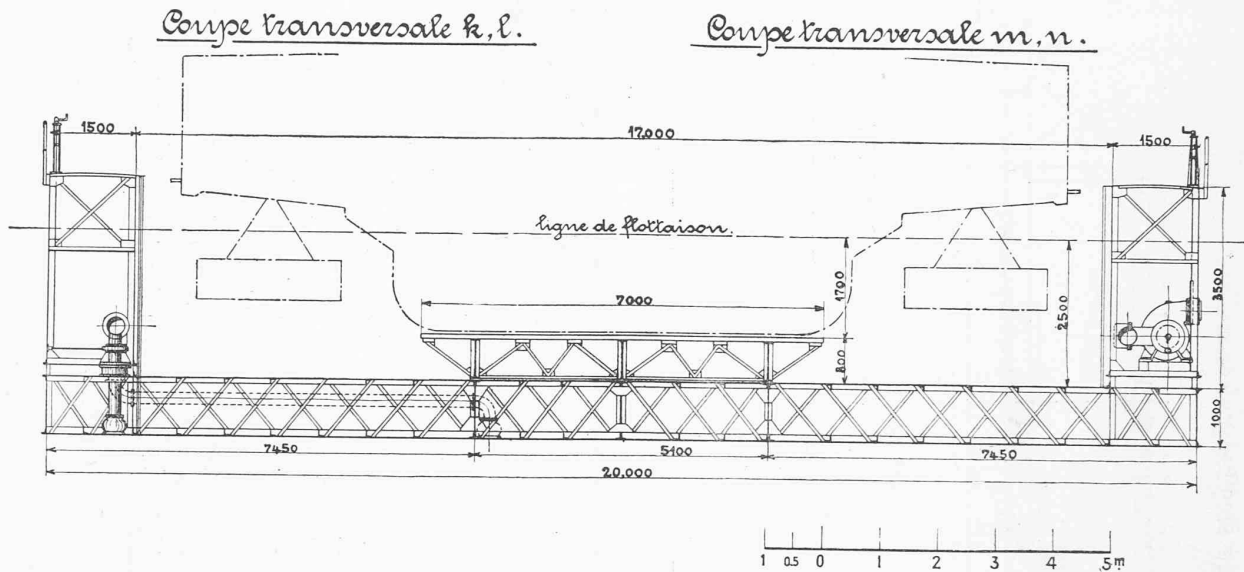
Coupe transversale du dock flottant d'Ouchy.
